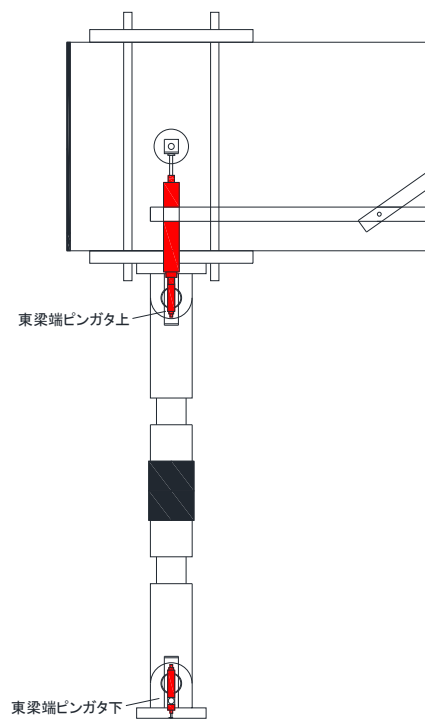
DR-1~4 基礎梁端変位計治具図面
